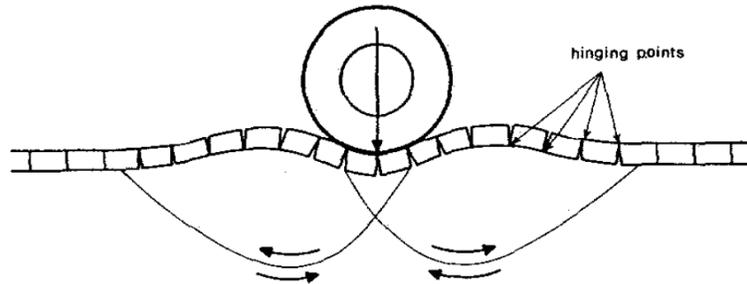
5: El comportamiento de un pavimento de bloques de hormigón bajo carga.
